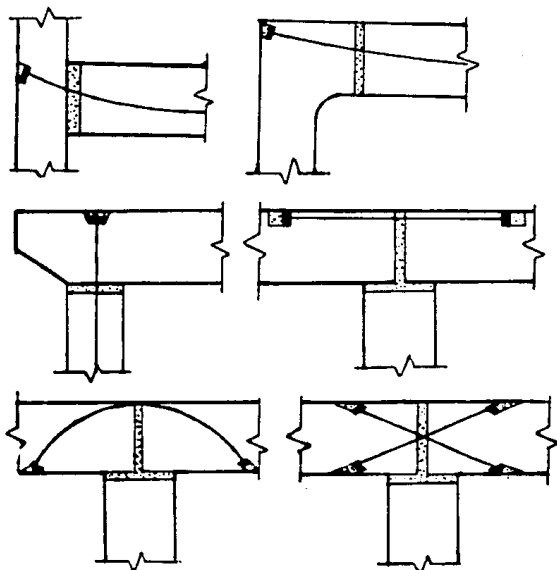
Principales soluciones para unir estructuras por la técnica del postensado.
